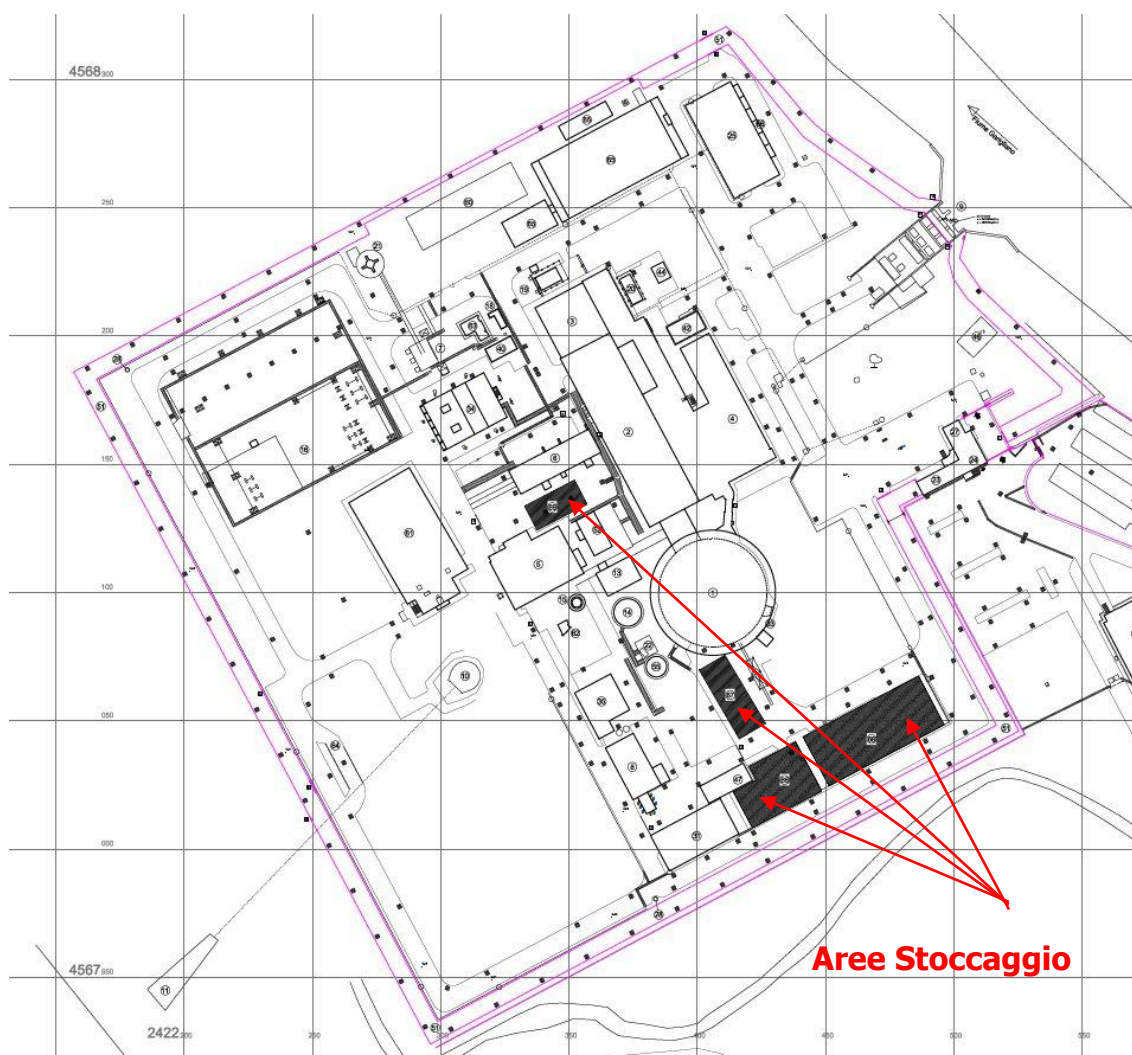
Planimetria Aree di stoccaggio (estratto da GRST00134)
